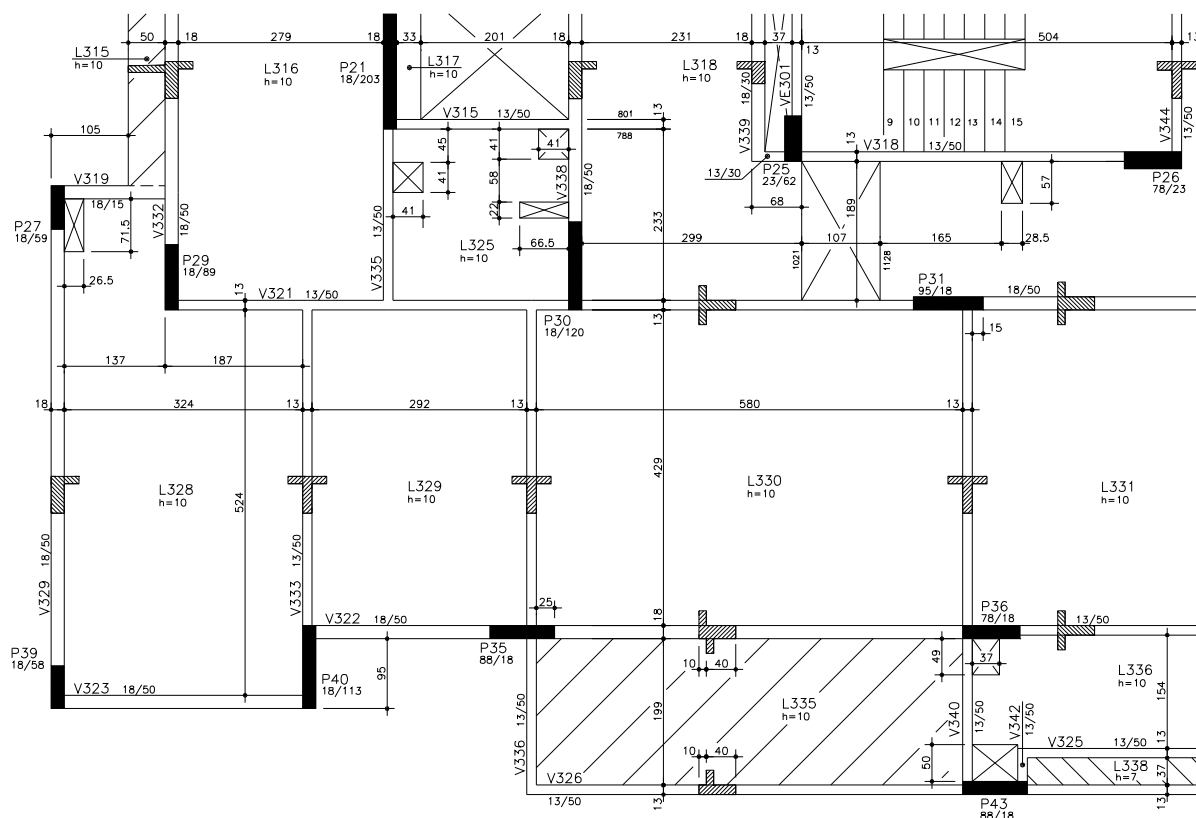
geometria dos elementos estruturais, correspondente a um apartamento do pavimento tipo.
